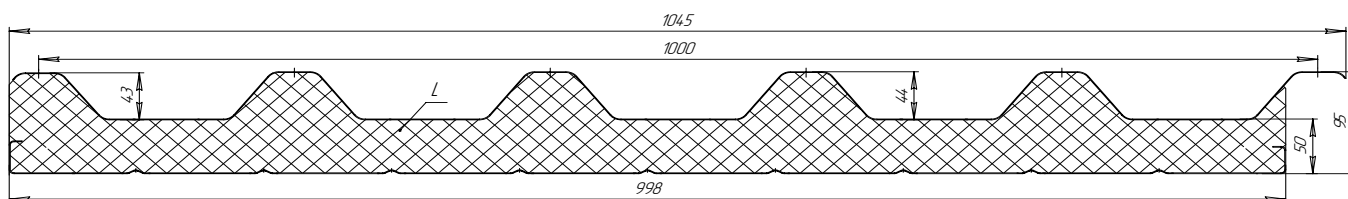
Панель трехслойная кровельная с монтажной шириной 1000 мм
